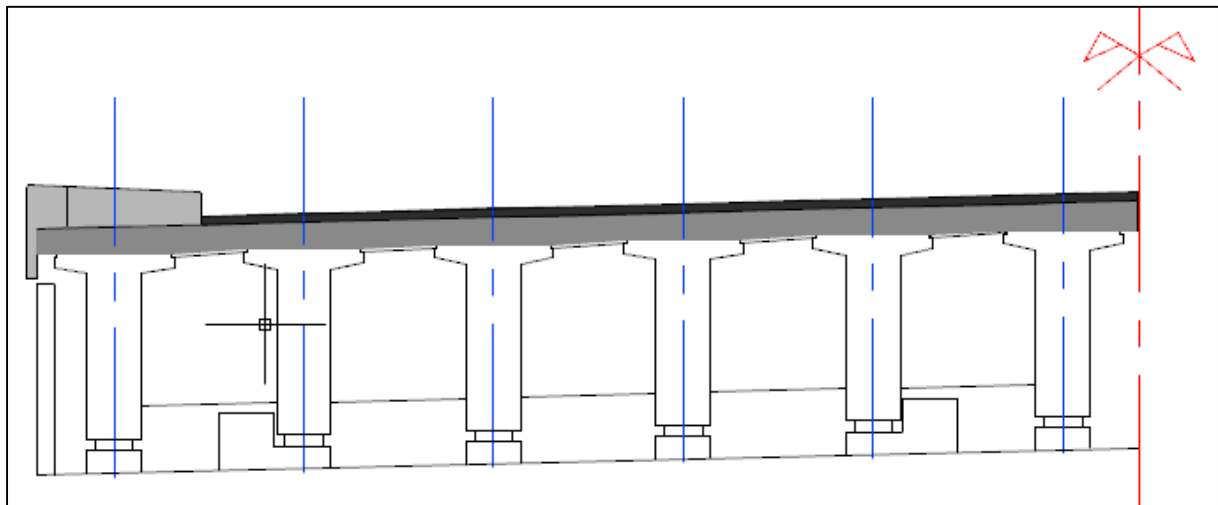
schéma de la dalle revêtement corniche et trottoir
